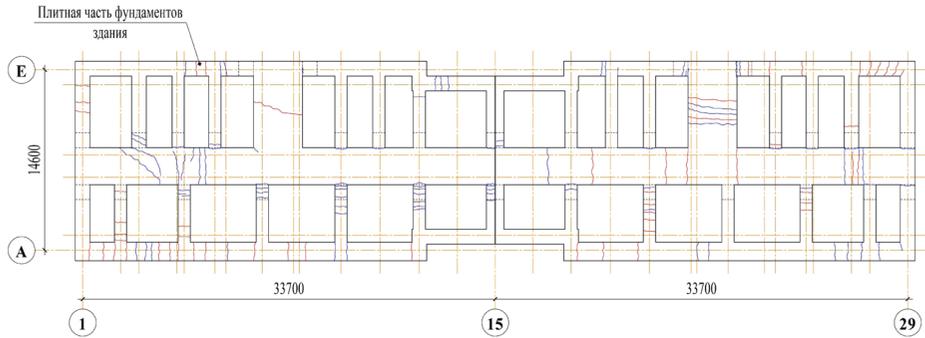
Схема расположения трещин в деформировавшейся плитной части фундамента
